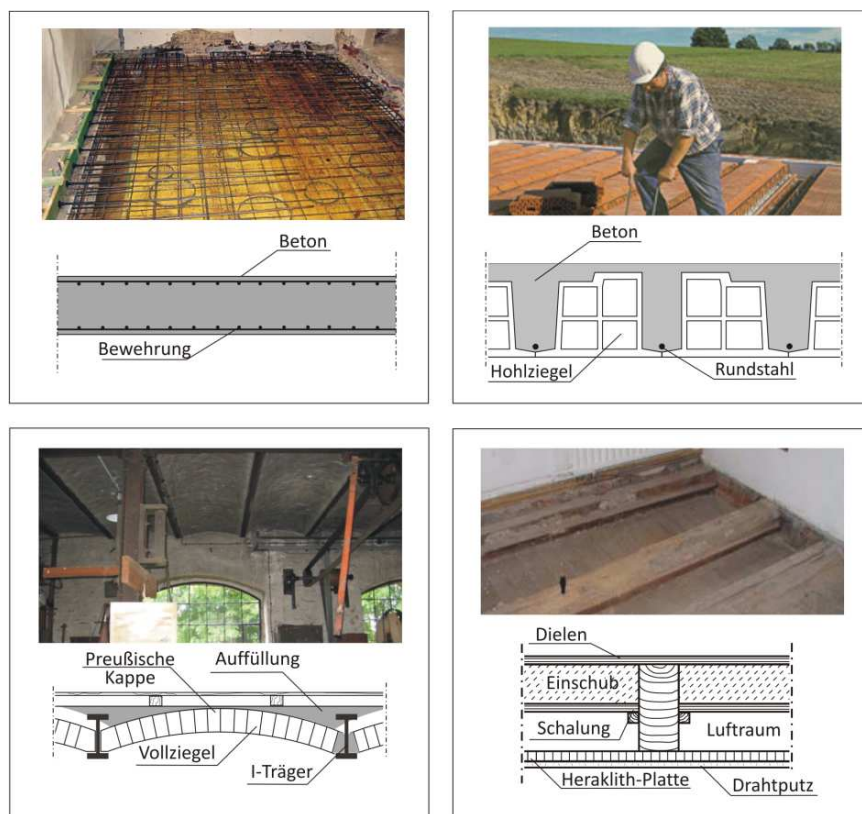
Die vier Deckentypen – Stahlbetondecke, Stahlsteindecke, Kappendecke, Holzbalkendecke
